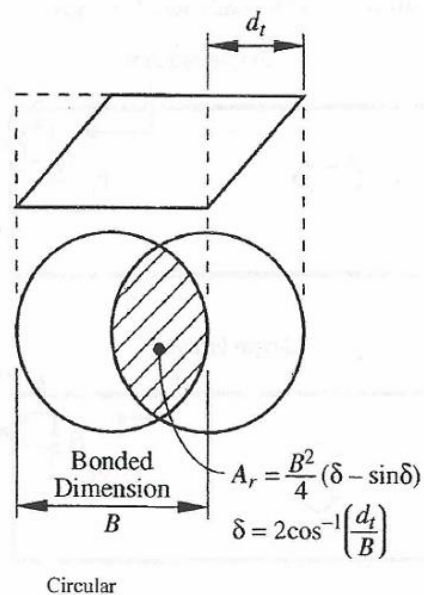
Vista en planta y elevación de la reducción del área del aislador debido a DTM.
